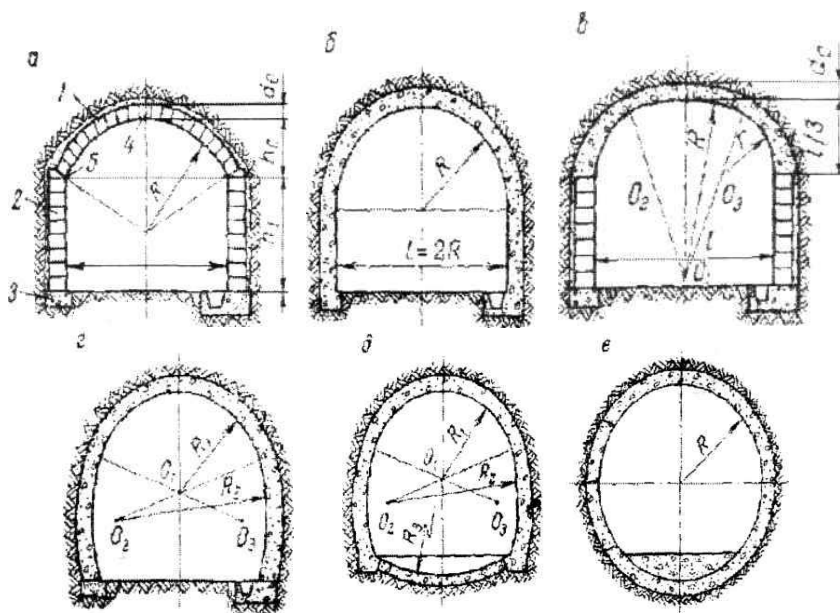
Конструкції кам'яного та бетонного кріплення
